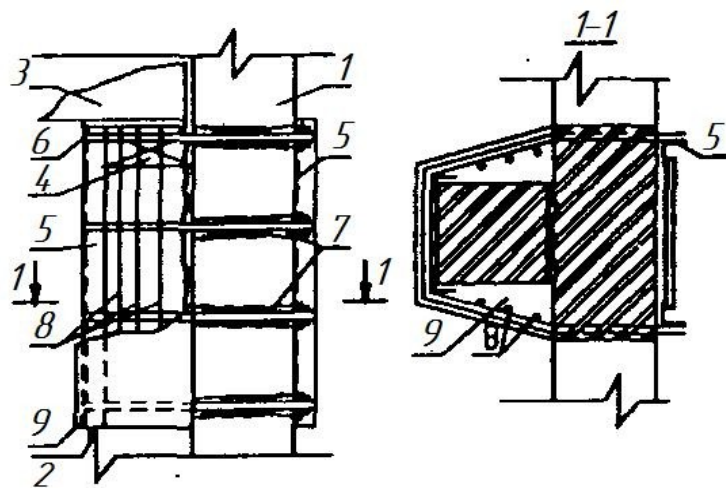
Посилення вузлів опирання балок і плит на цегляні стіни влаштуванням залізобетонних обойм:
